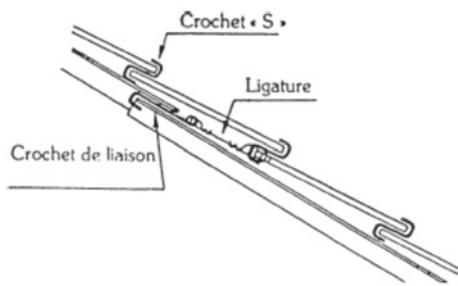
bis – Fixation des tuiles au recouvrement de plaques
